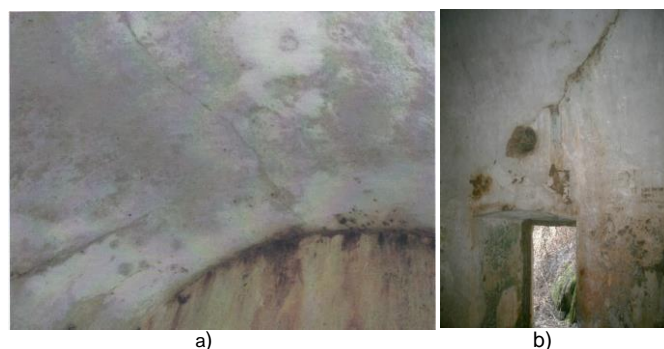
Fissuras observadas no interior da construção que encosta na barragem do Monte Branco: a) fissura no fecho da abóbada do teto e b) fissura interior na parede esquerda da construção (retirado de Tetraplano, 2002).
